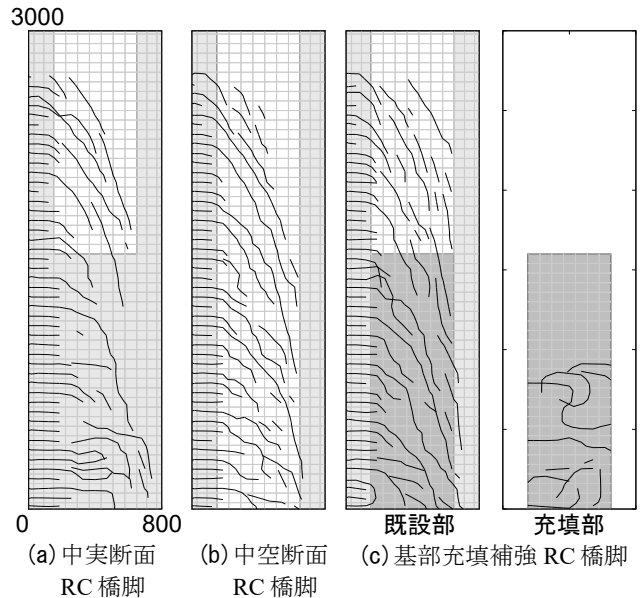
$3\delta y$ 時のひび割れ性状(Unit:mm)
